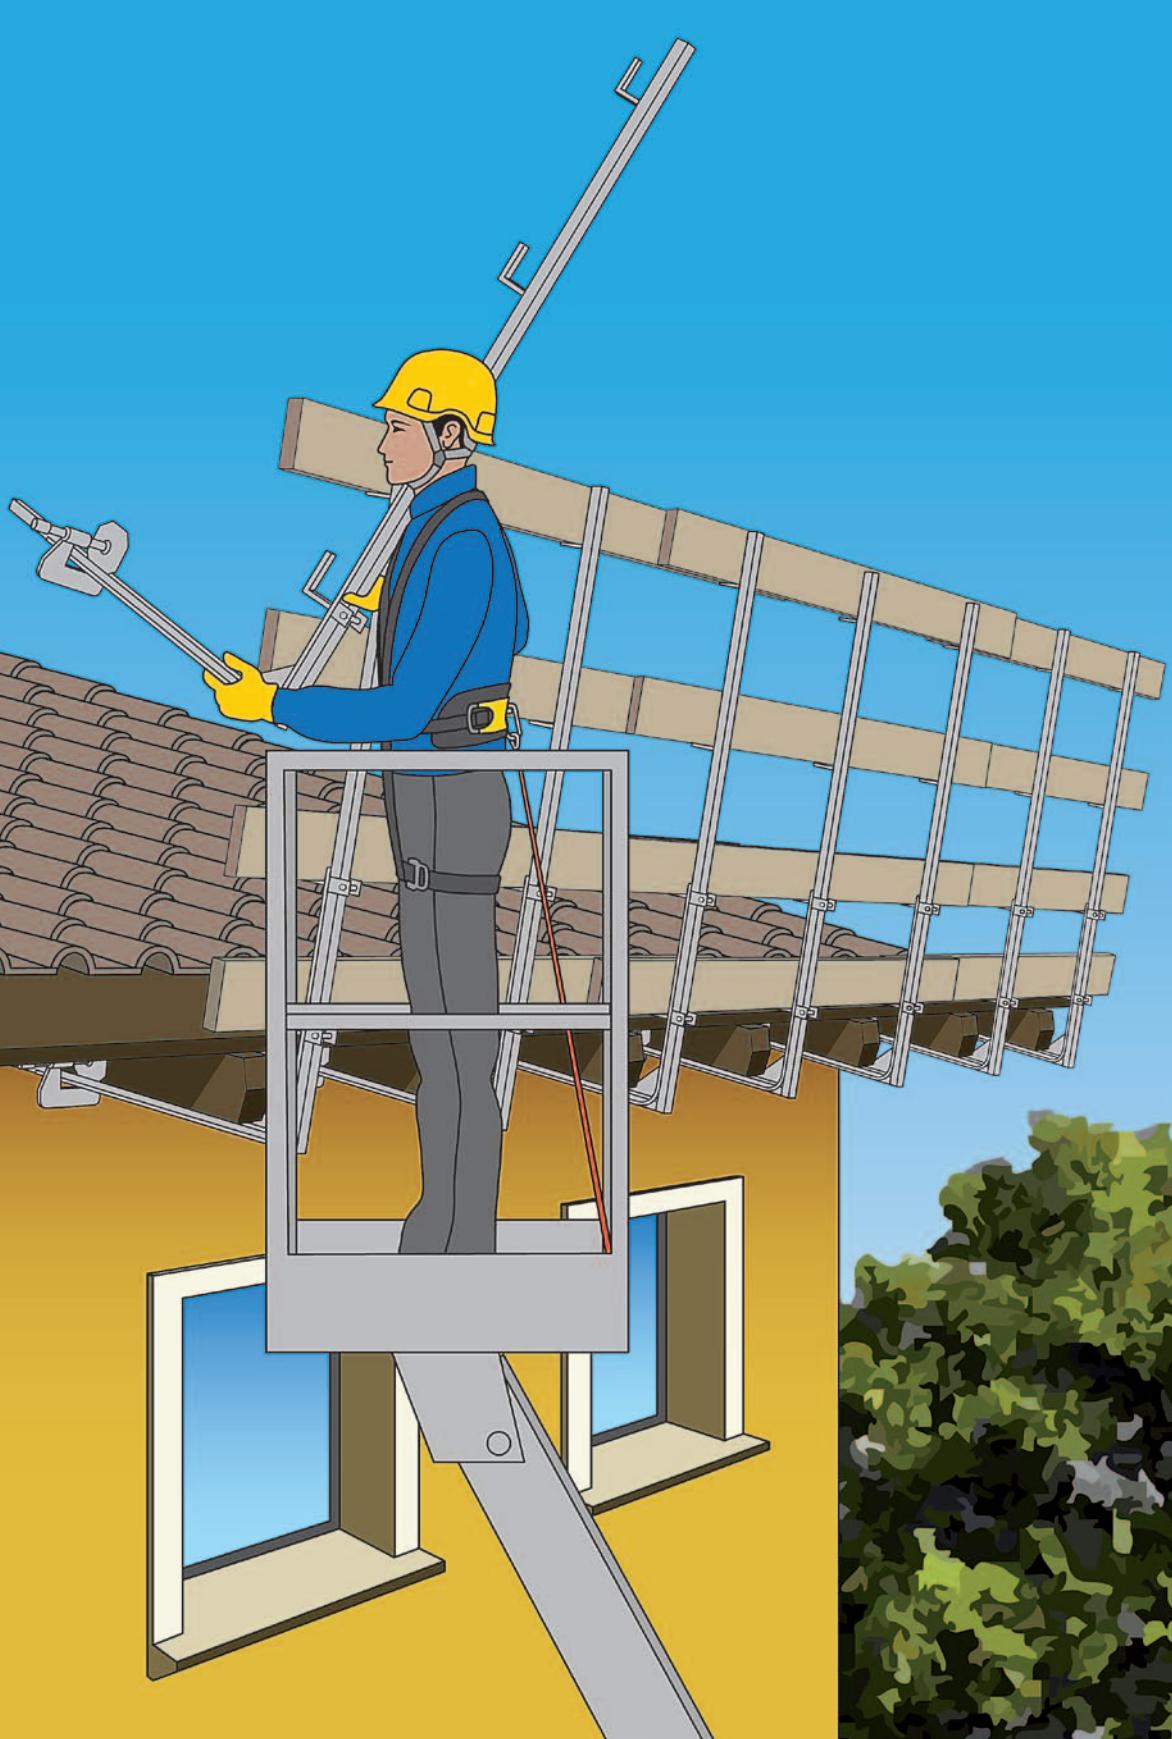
Parapetto provvisorio, montaggio/ smontaggio
